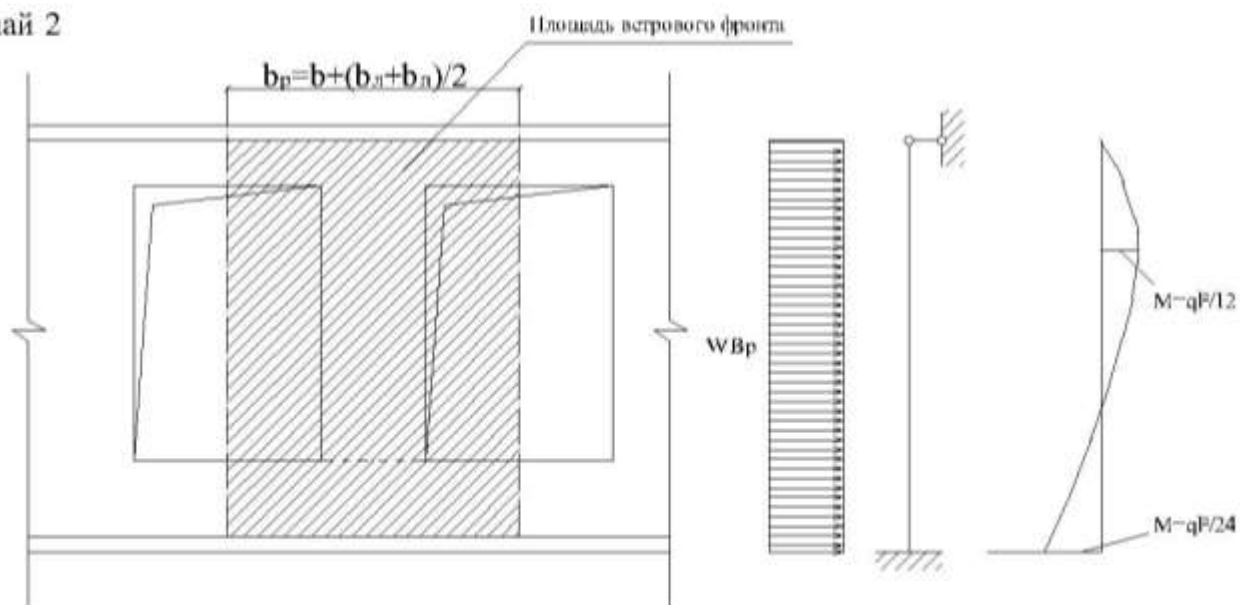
К расчету простенка, расположенного вне несущих поперечных стен, в стадии возведения
